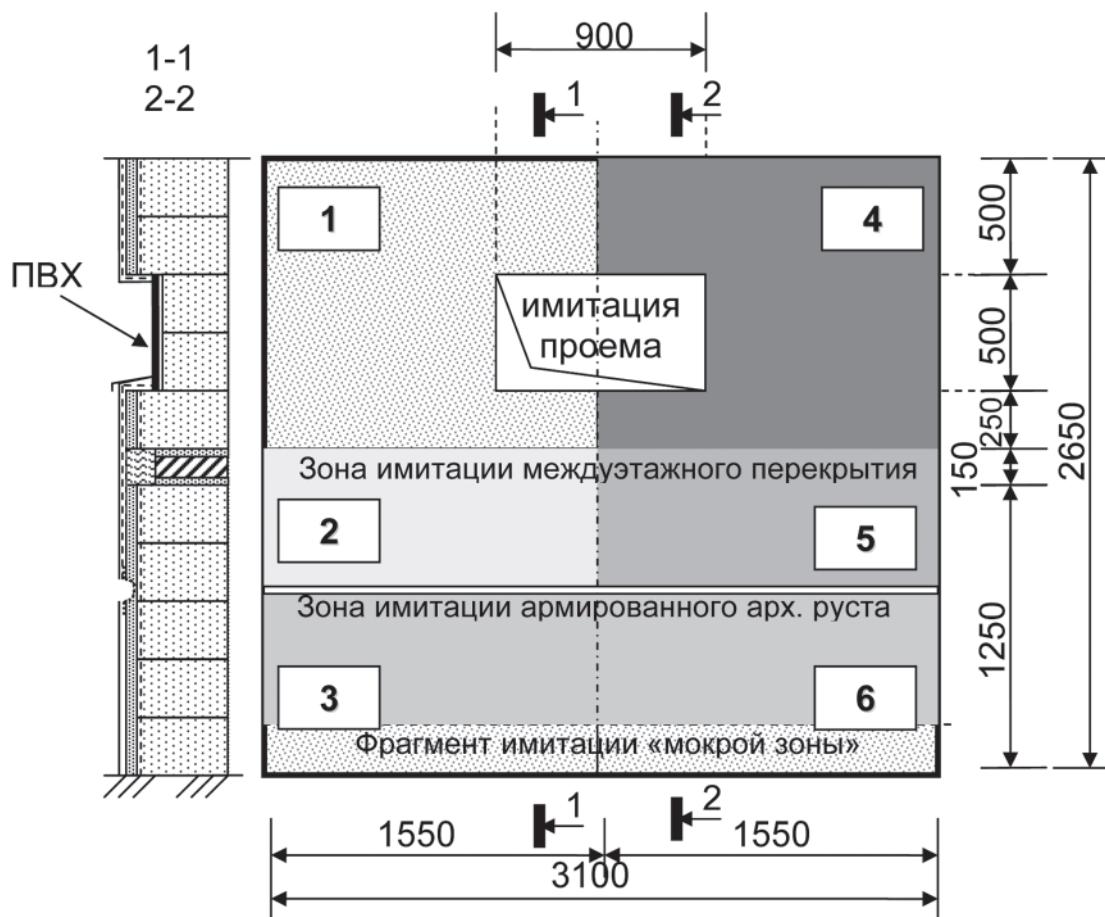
Схема фрагмента стены из газобетонных блоков с защитно-декоративной отделкой Ceresit
